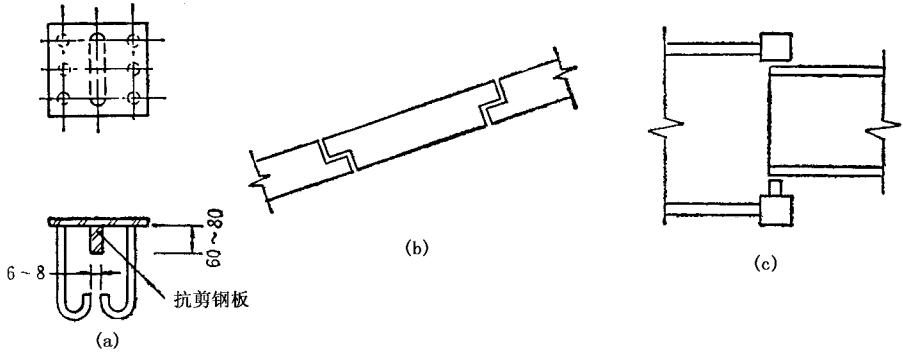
钢筋混凝土栈桥和走廊抗震构造
